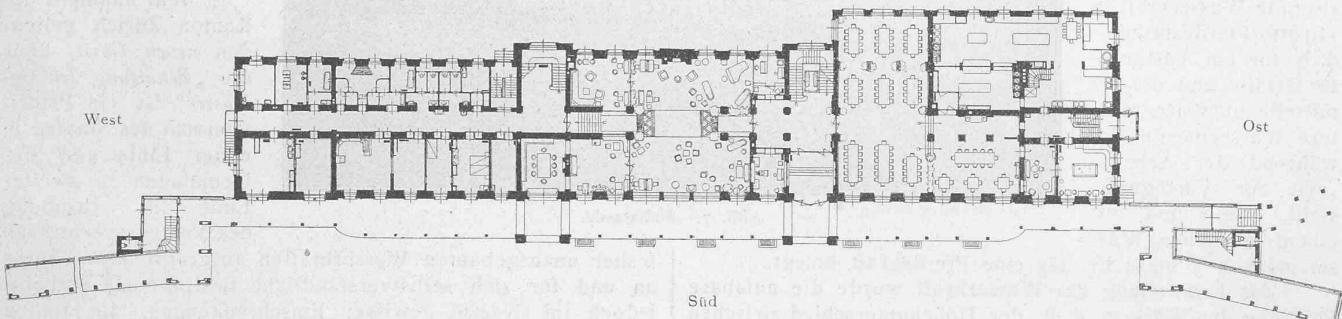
Grundriss vom Erdgeschoss. — Masstab 1:750.
